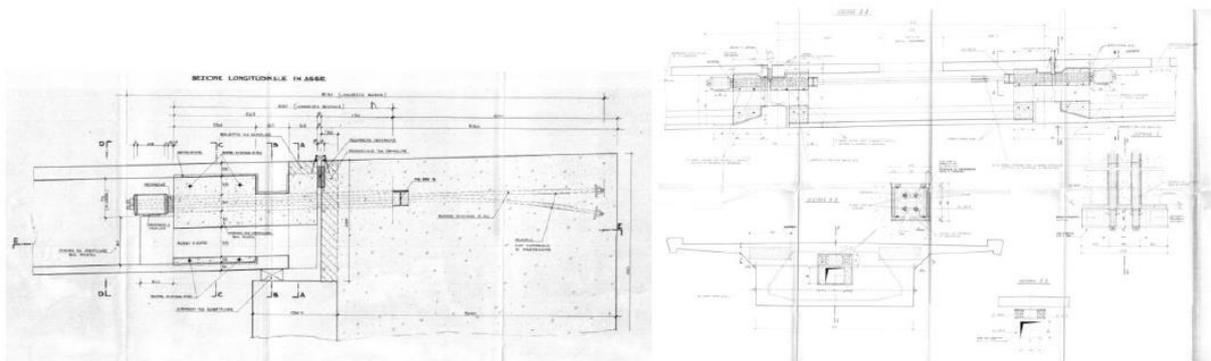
Collegamento spalla lato Celico a) Collegamento travi tampone b)
